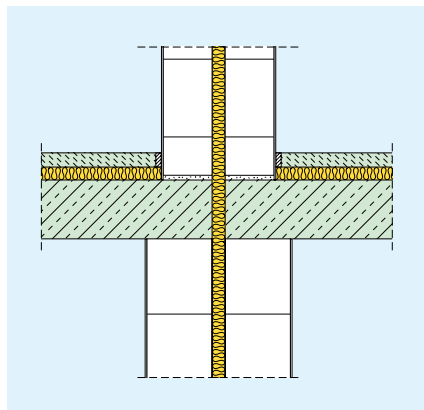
Zwischendeckenanschluss einer zweischaligen Haustrennwand
